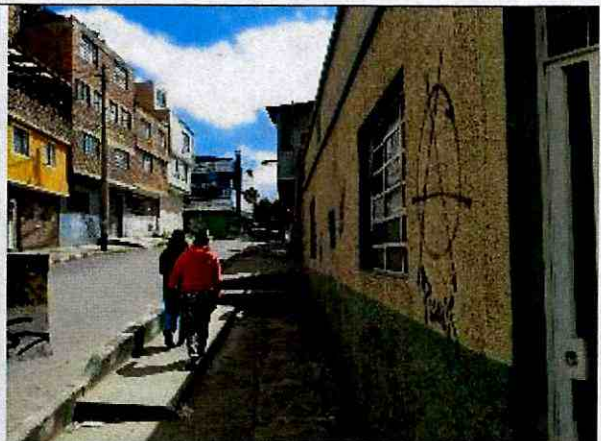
Fachada de la vivienda localizada en Calle 50 B Sur No. 31-96, en el Barrio Samore de la Localidad de Tunjuelito.
